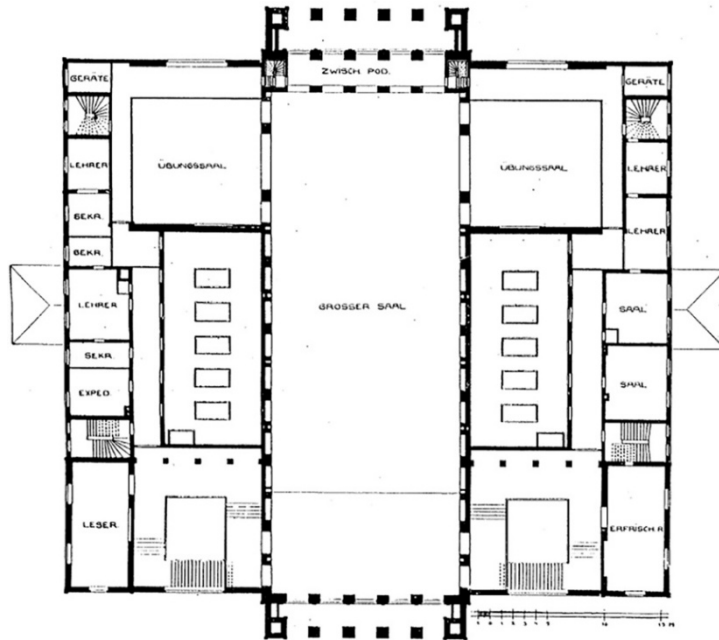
Heinrich Tessenow, plan du 2^e étage de l'Institut Jaques-Dalcroze, 1911.
